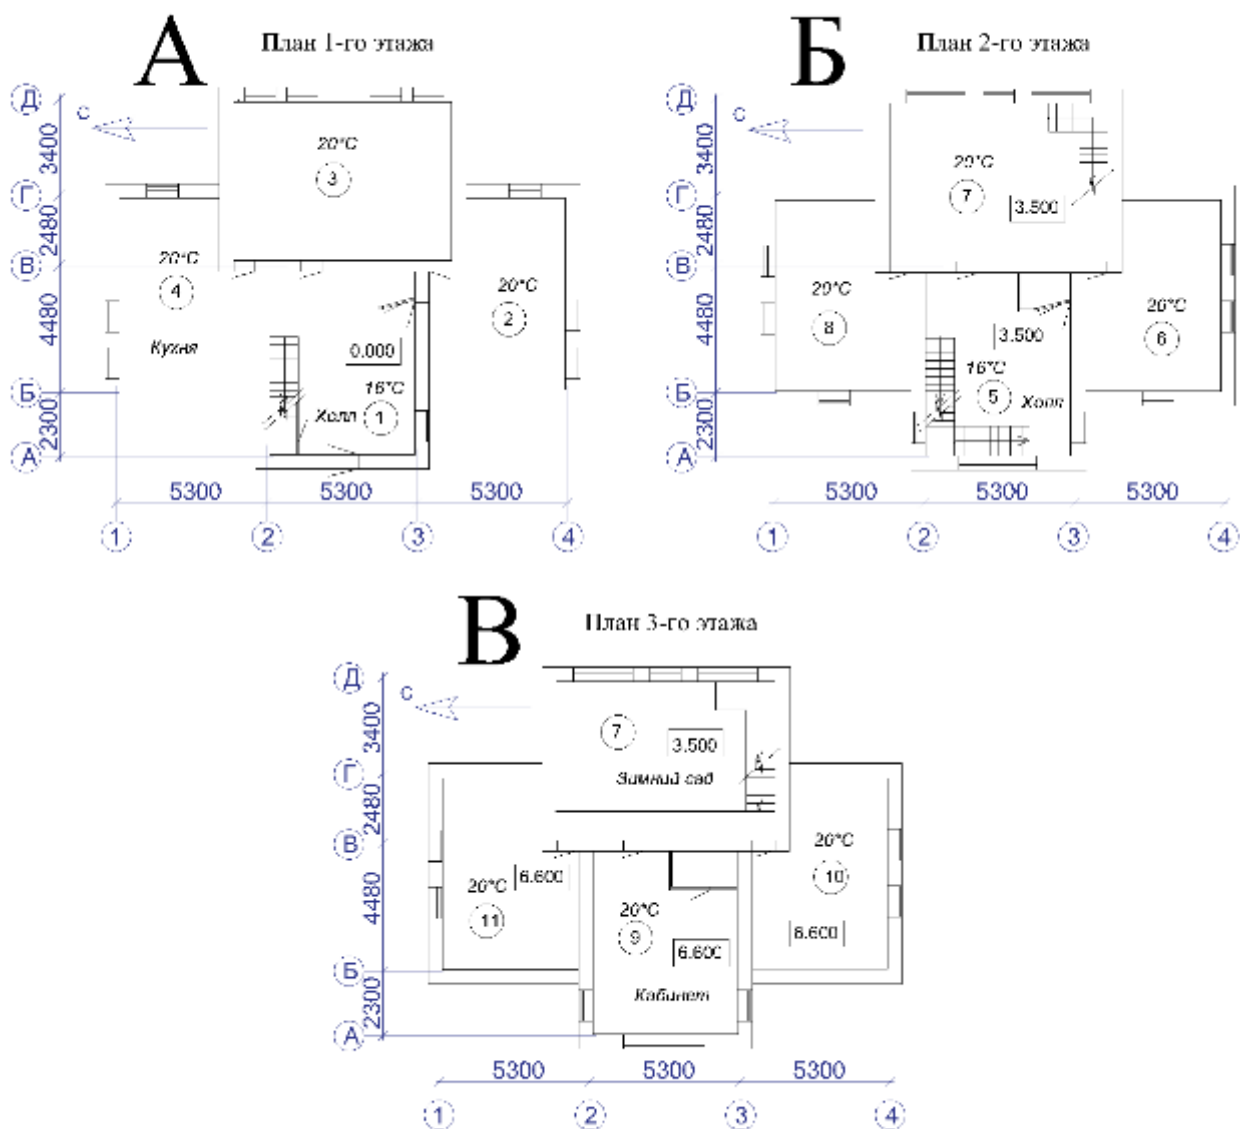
Планы индивидуального жилого дома: А – план первого этажа, Б – план второго этажа, В – план третьего этажа
